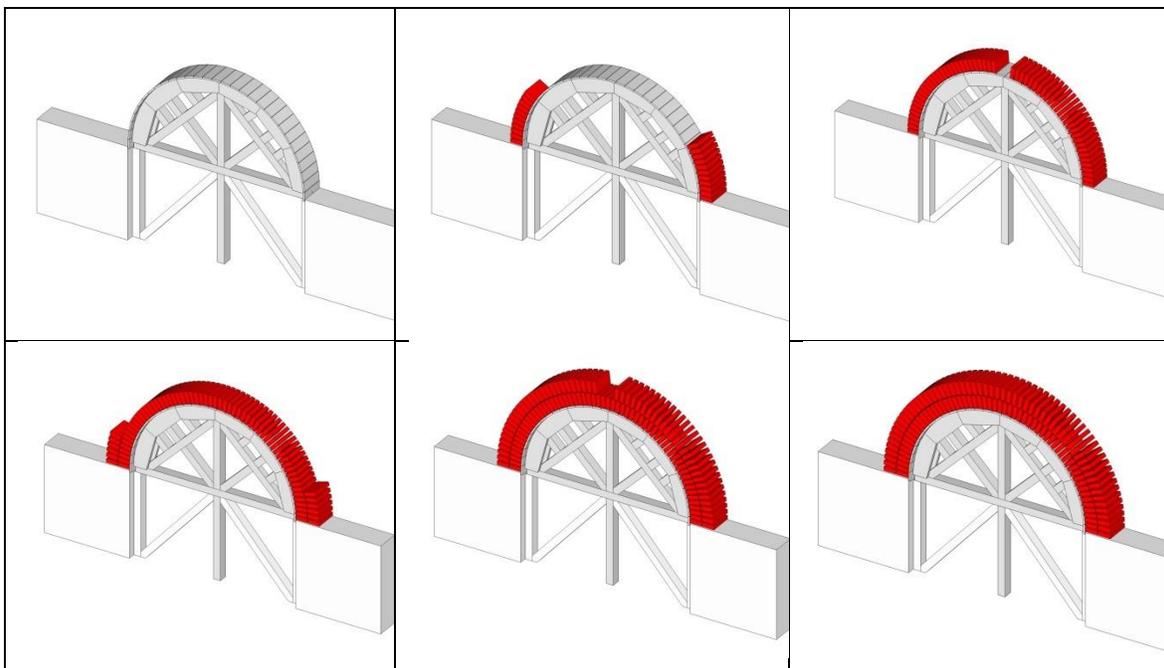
Esquemas de secuencia de construcción hipotética de arco con hilada longitudinal al eje. Elaboración propia.
